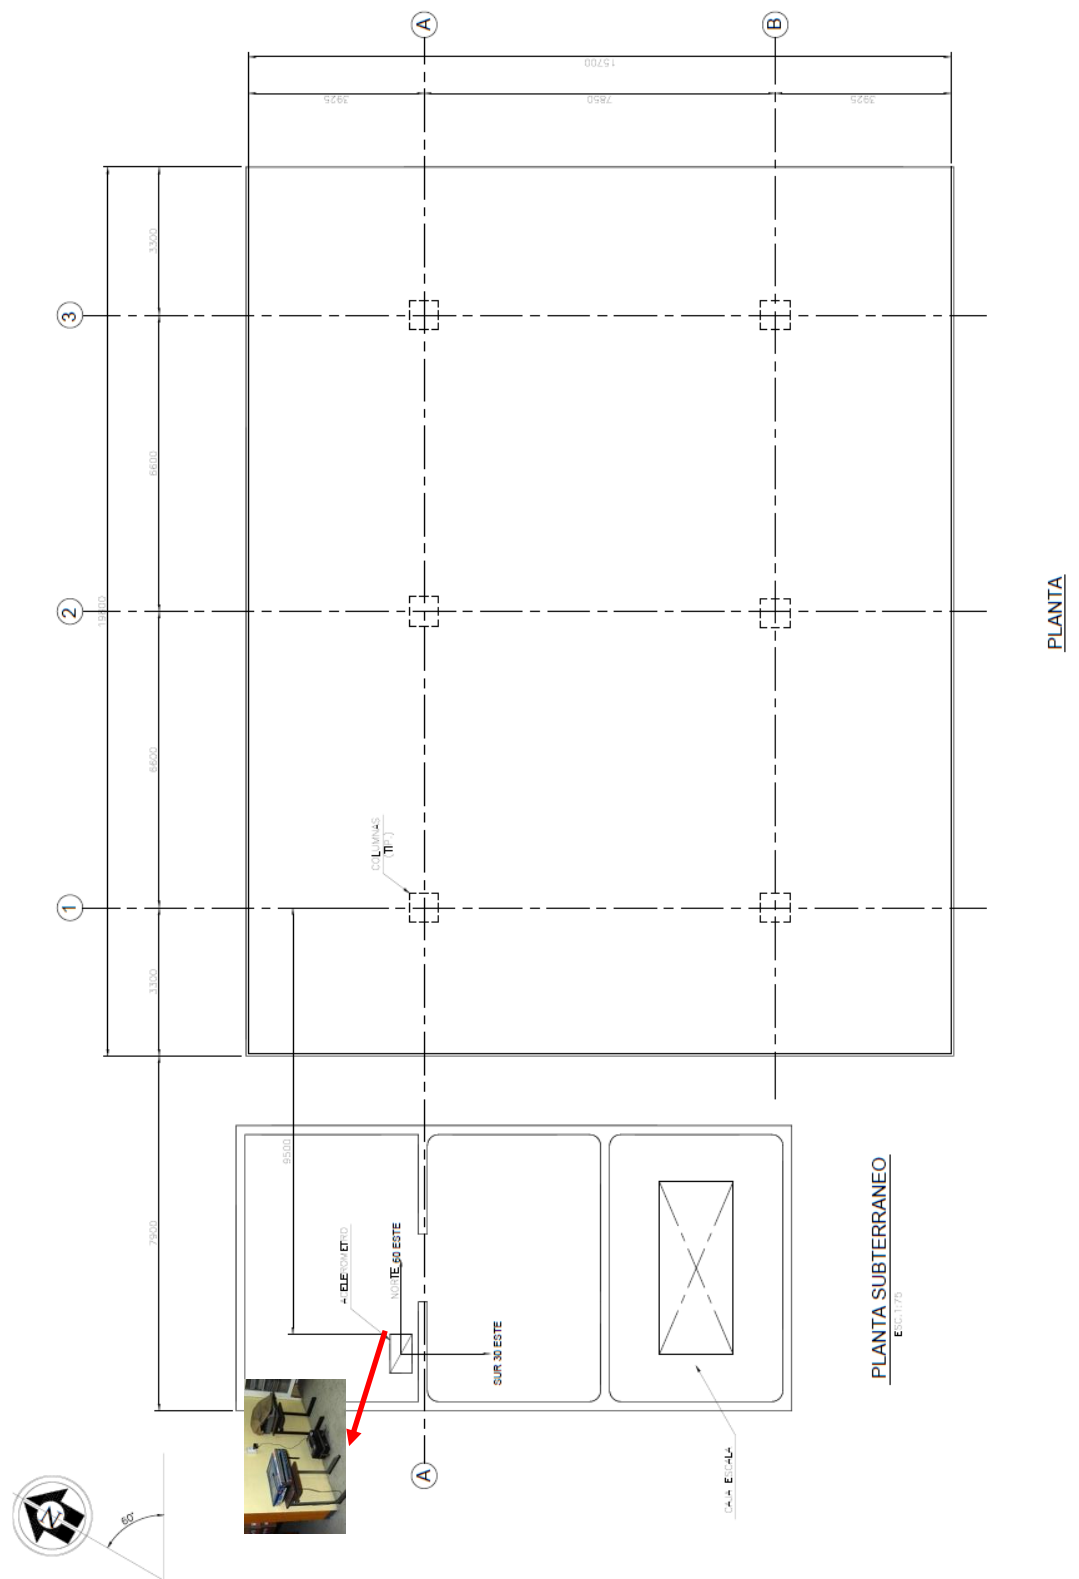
Vista en planta del canopy y ubicación del acelerógrafo en el subterráneo (Dimensiones en milímetros).
